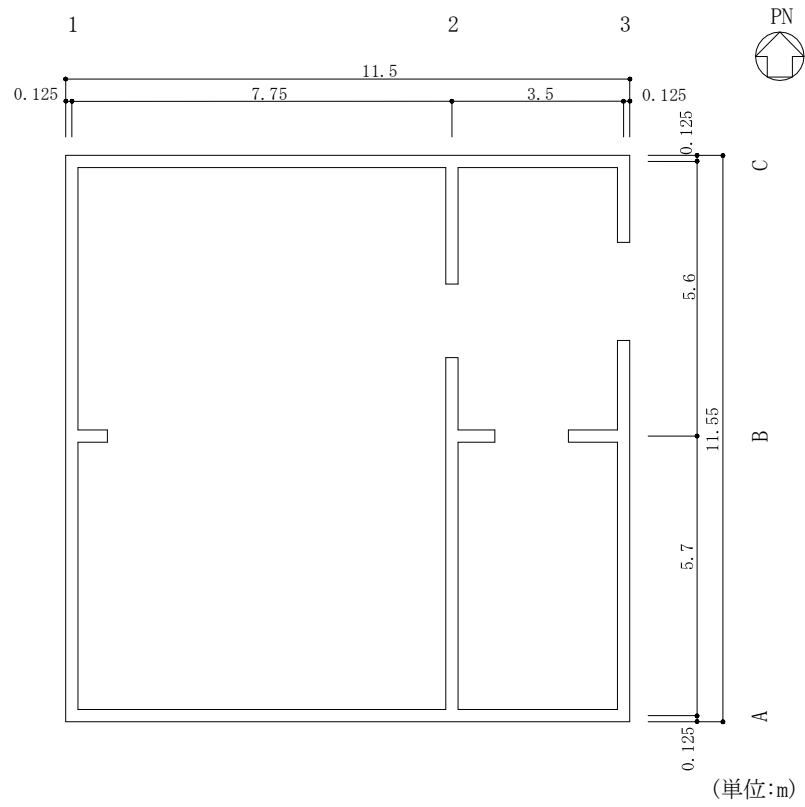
排気筒モニタ室の概略平面図 (EL 8.8m*)
